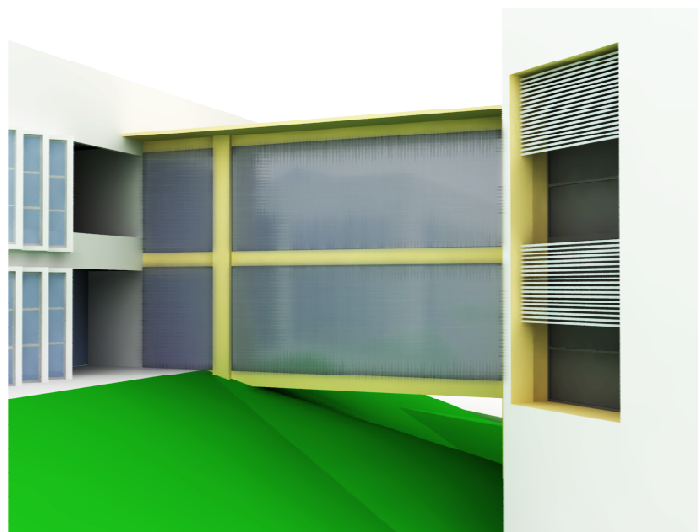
Janelas voltadas para oeste vistas em perspectiva, na segunda alteração.
